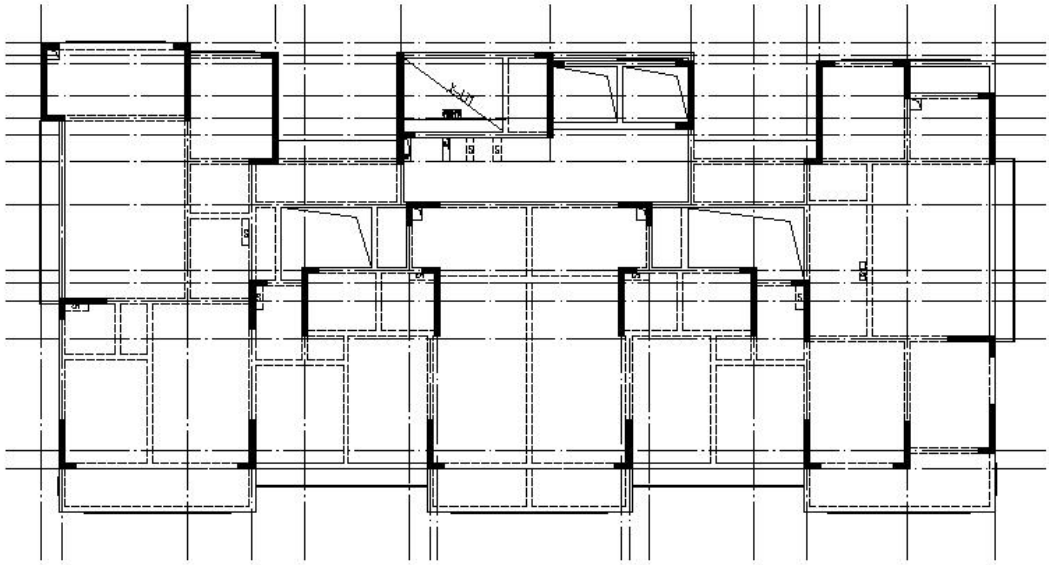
调研楼栋标准层结构平面图（建筑面积约 420 平方）
